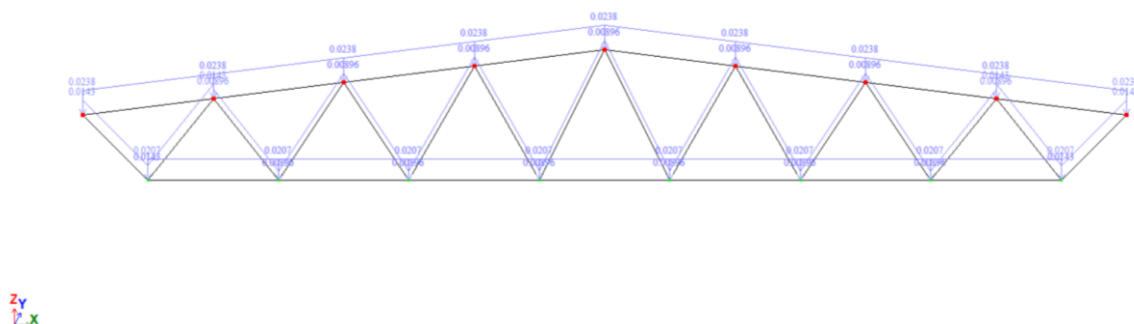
Расчетная схема стропильной фермы проектируемого здания
